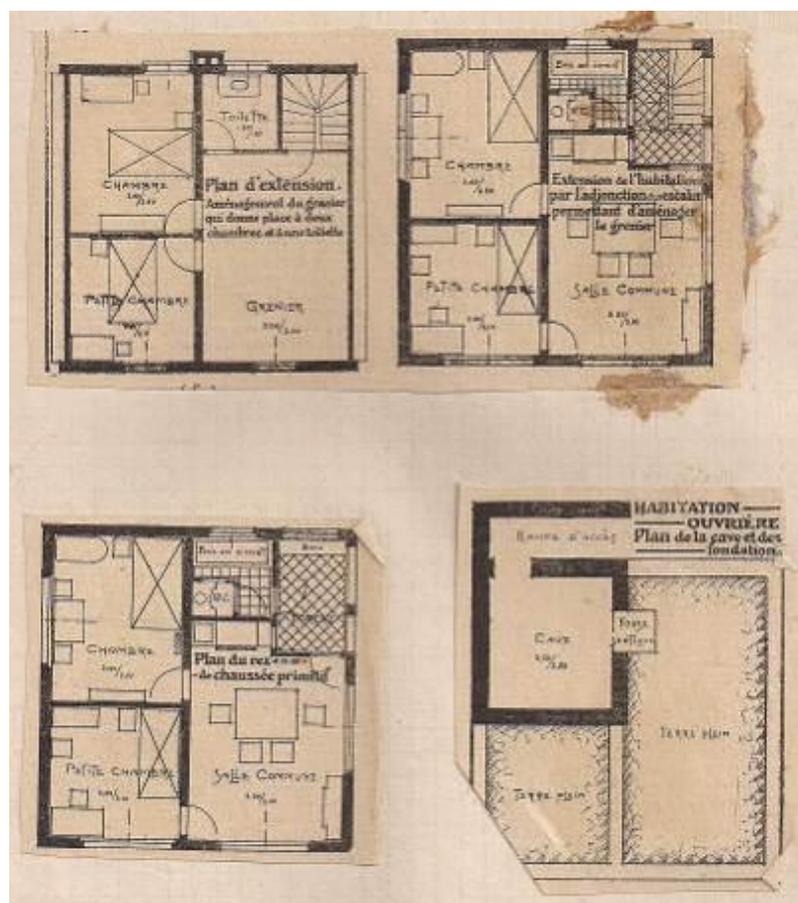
Proposta de habitação, trabalho acadêmico “Rapport sur la reconstruction du village Aix-Noulette”, ESTP, 1921-1922.
